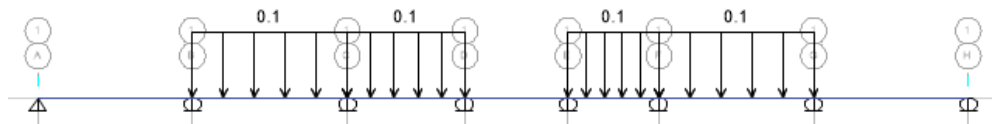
Carga viva distribuida en vigueta de losa aligerada – Damero 4
